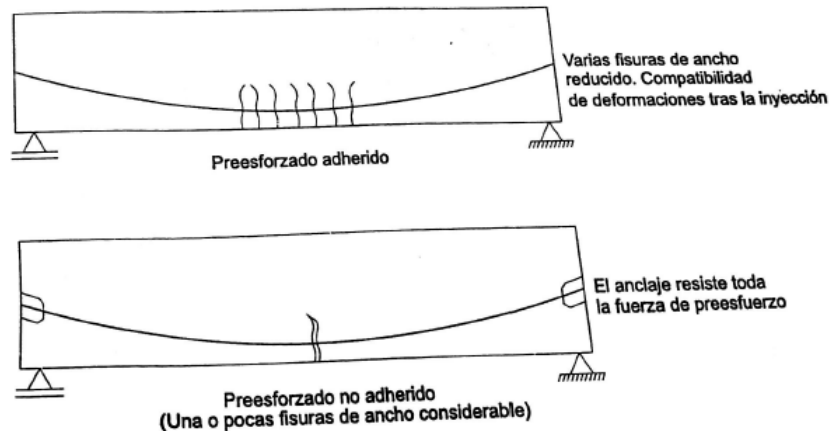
Formación de fisuras en preesfuerzo adheridos y no adheridos [33]
